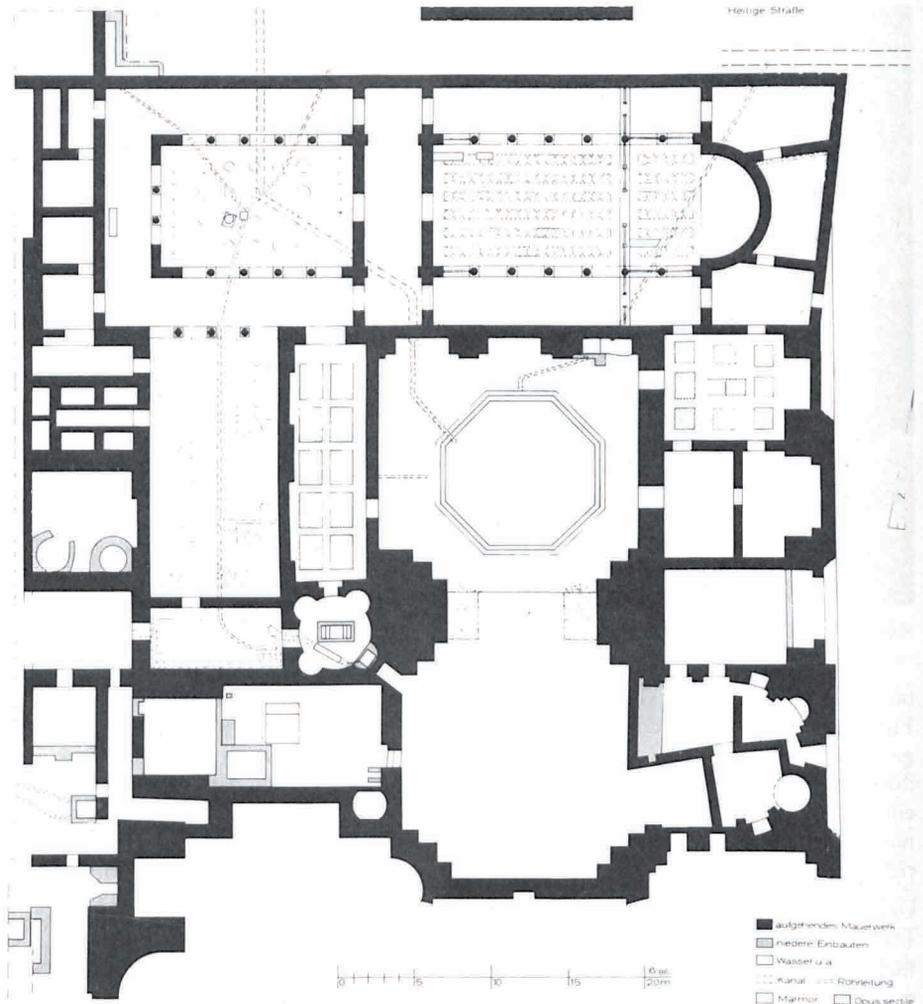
Rekonstruierter Grundrißplan der Gesamtanlage.
